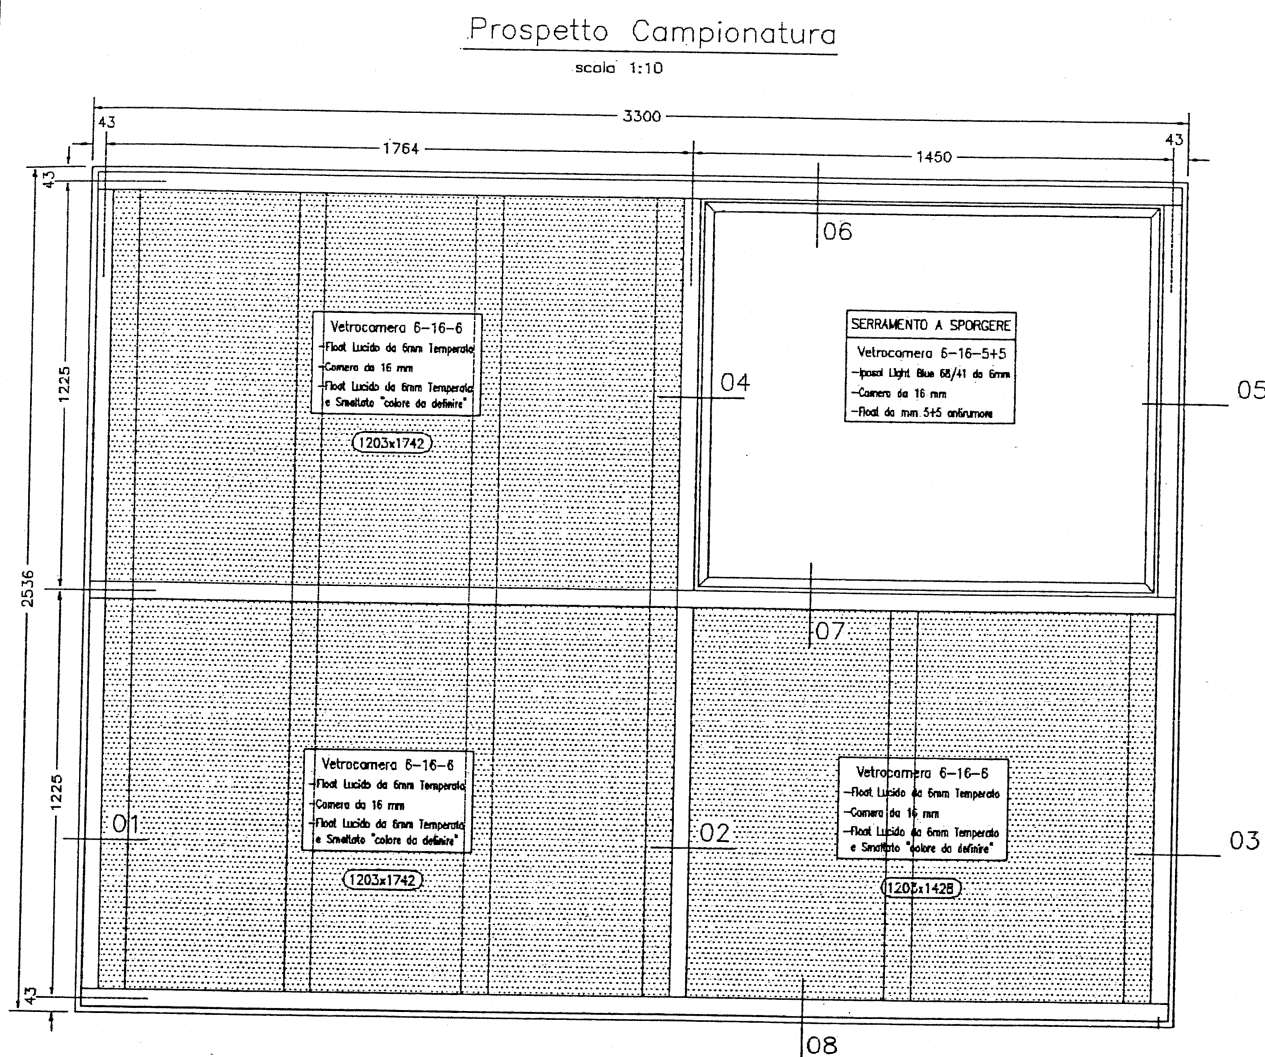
Schema dell'elemento sottoposto a prova. Prospetto.
